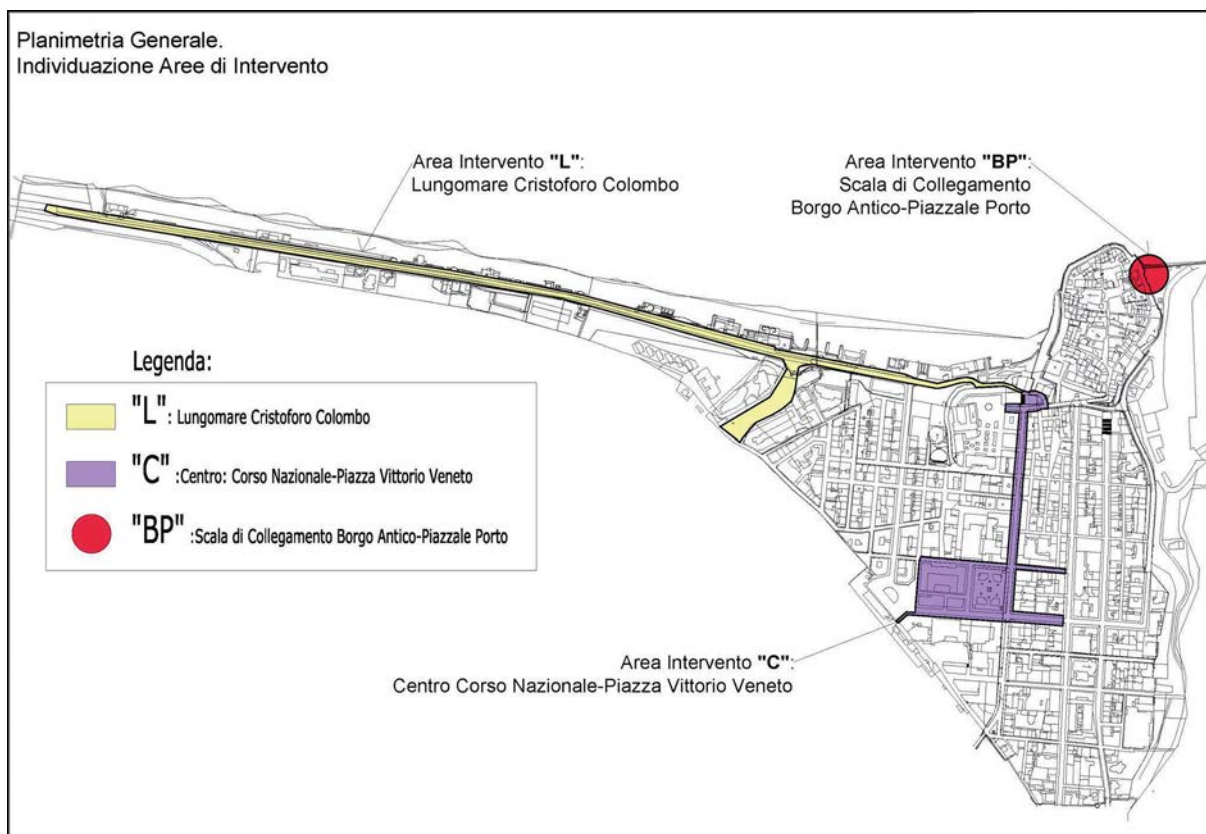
Planimetria generale del progetto "Riqualificazione del Lungo Mare Nord" (fonte Comune di Termoli)
